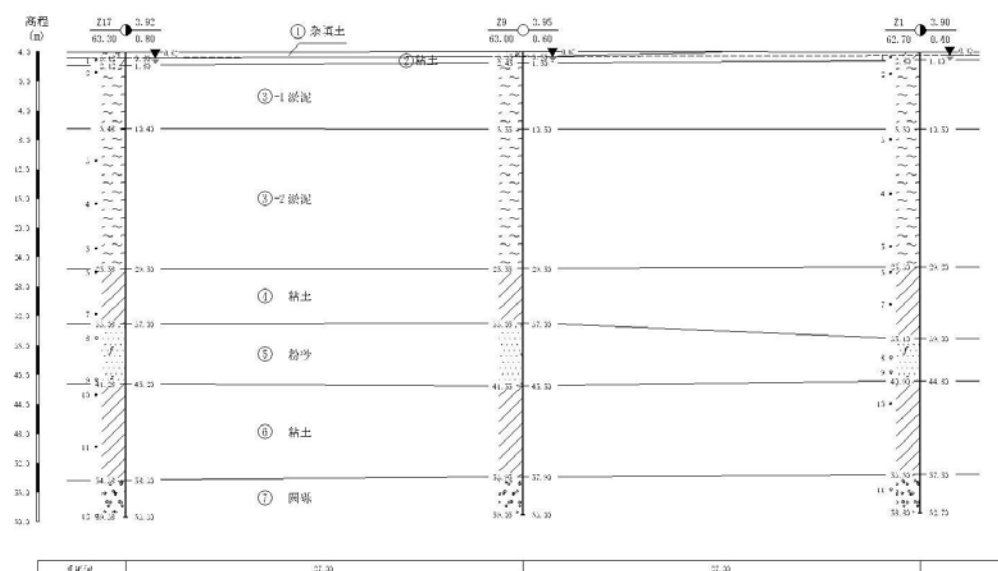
项目所在区域地层岩性 4-4' 典型剖面图
